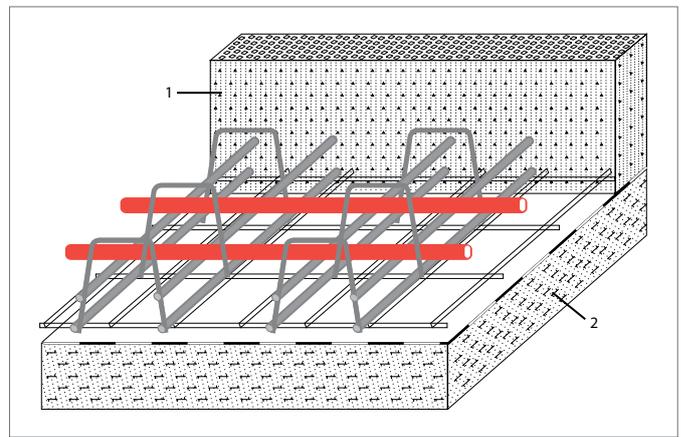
Mit Stahlmatten bewehrte Bodenplatte; Sonderkonstruktion Heizungsrohre mittig in der Platte montiert
